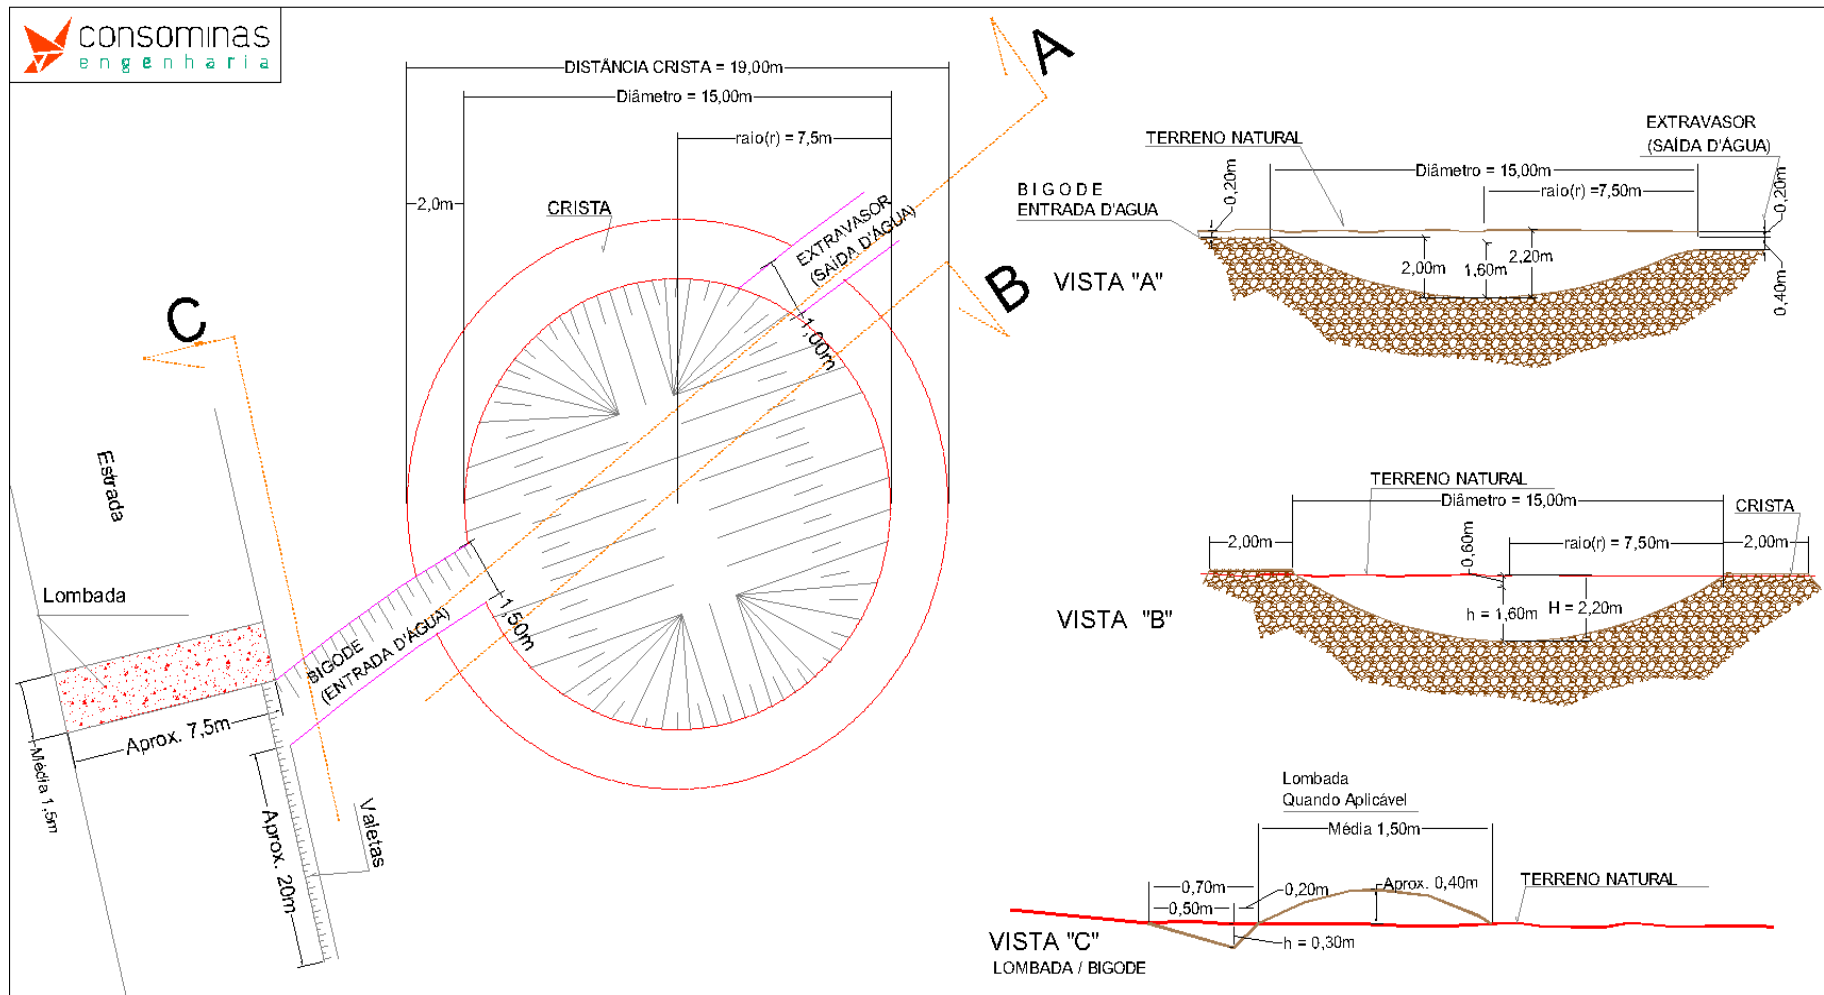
Planta e perfil de bacia de contenção do Tipo I e suas estruturas acessórias.
